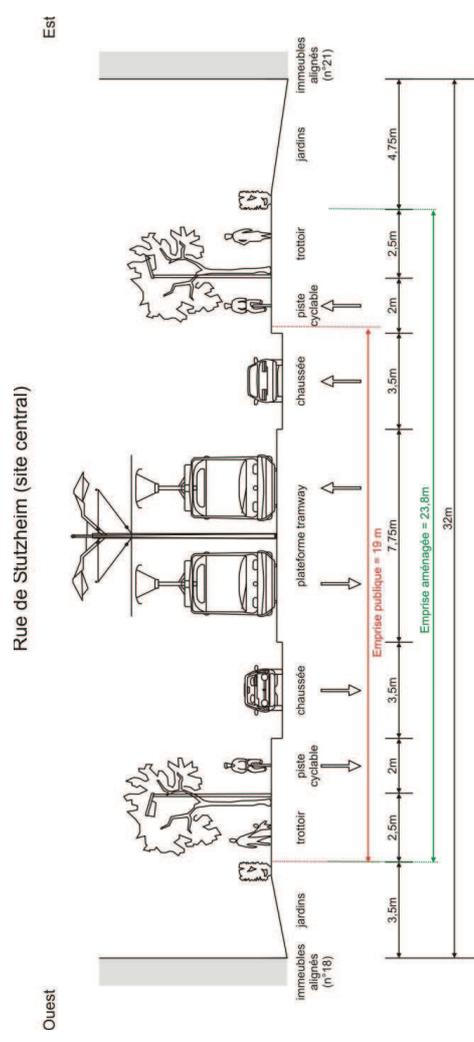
Situation projetée coupe 5 sur la rue de Stutzheim (site central)
